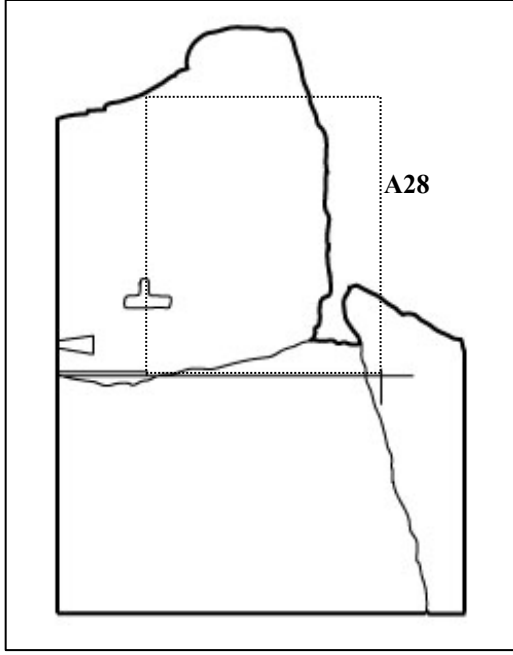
G9'un üst yüzeyindeki yerleştirme hattını gösteren eleman planı
